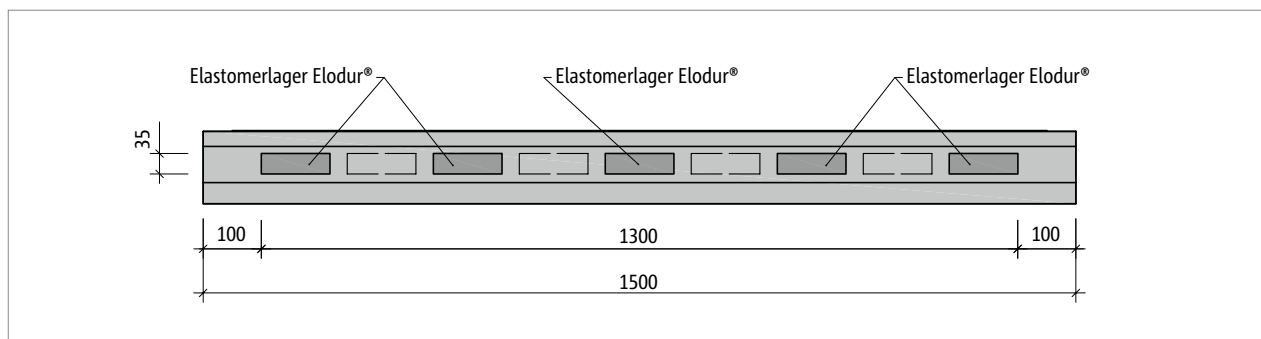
Schöck Tronsole® BL, BZ: Grundriss, beispielhafte Darstellung Tragstufe V1, Länge 1500 mm
